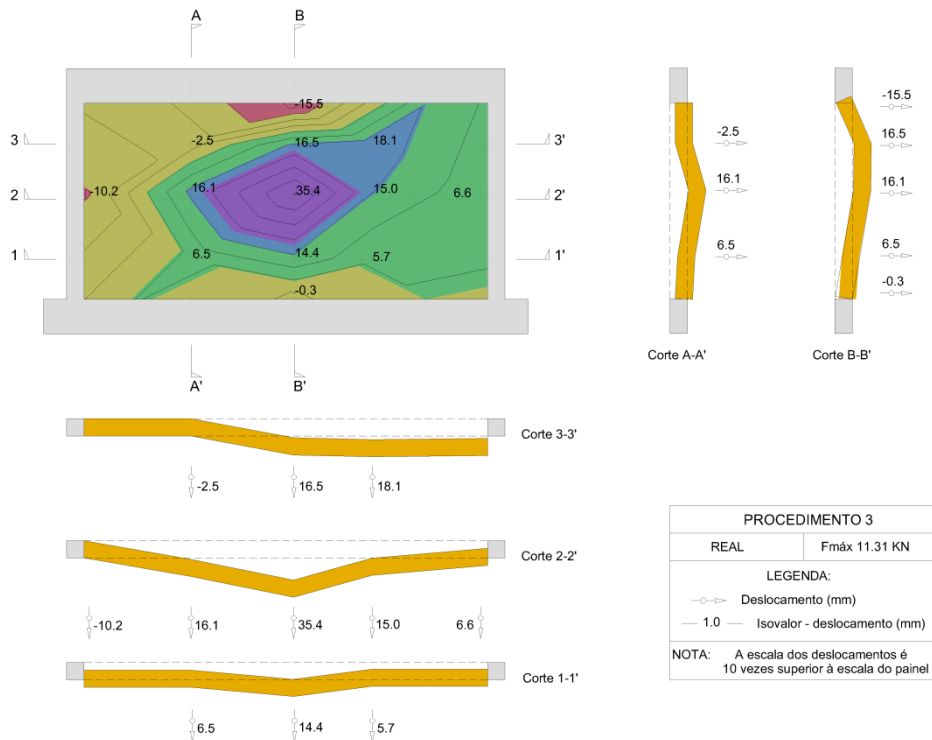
Isovalores da parede ensaiada - Procedimento 3. Ensaio fora do plano, Wall_DPA_01.
